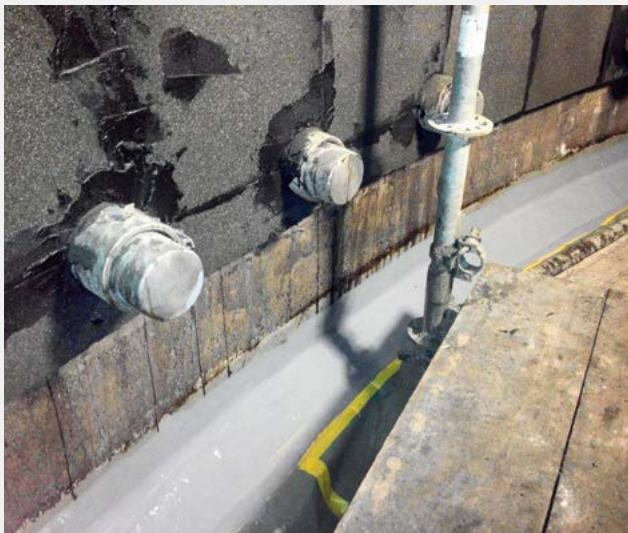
Übergang Trichter-Zylinder mit Fugendichtung und Rohranschlüssen in den FR
